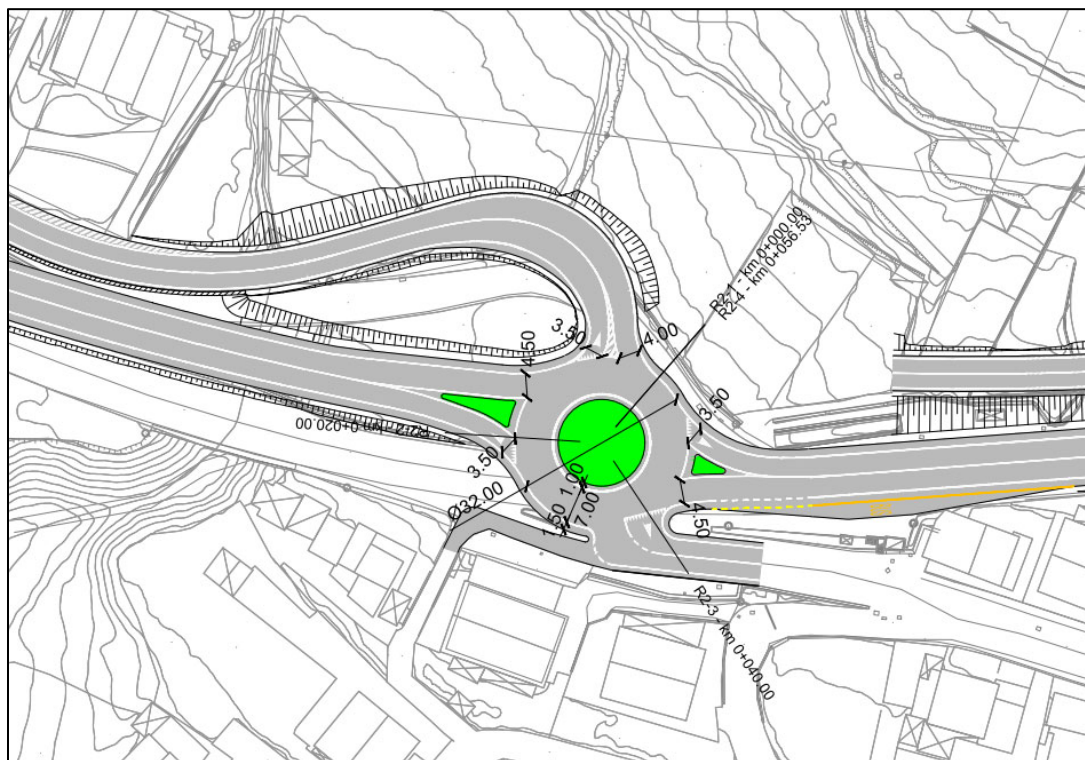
Estratto di planimetria di progetto della rotatoria 2
